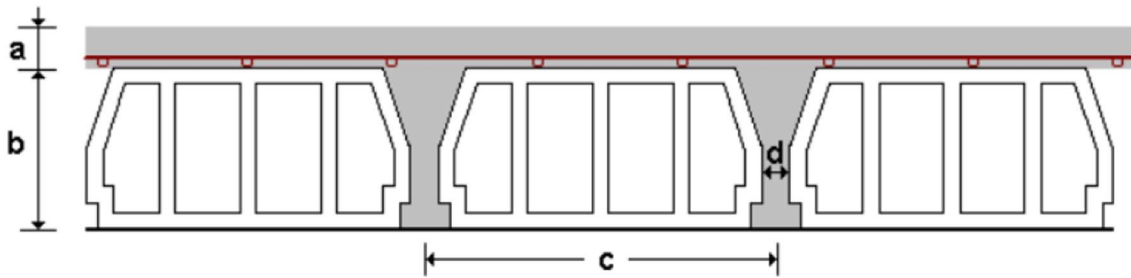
Detalle de forjado de viguetas y bovedillas 30+5
